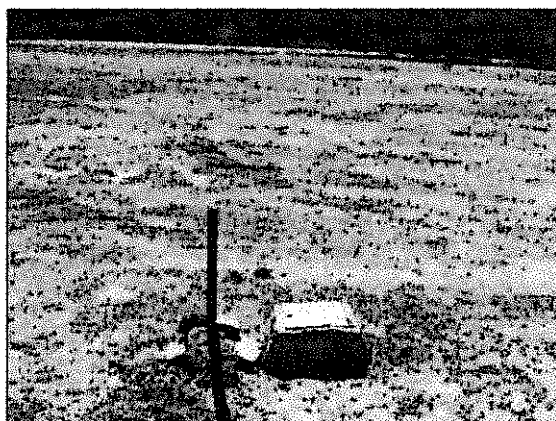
Instalación de Piezómetro PZ - 01, ubicado en la parte baja del Botadero de Ripios.
